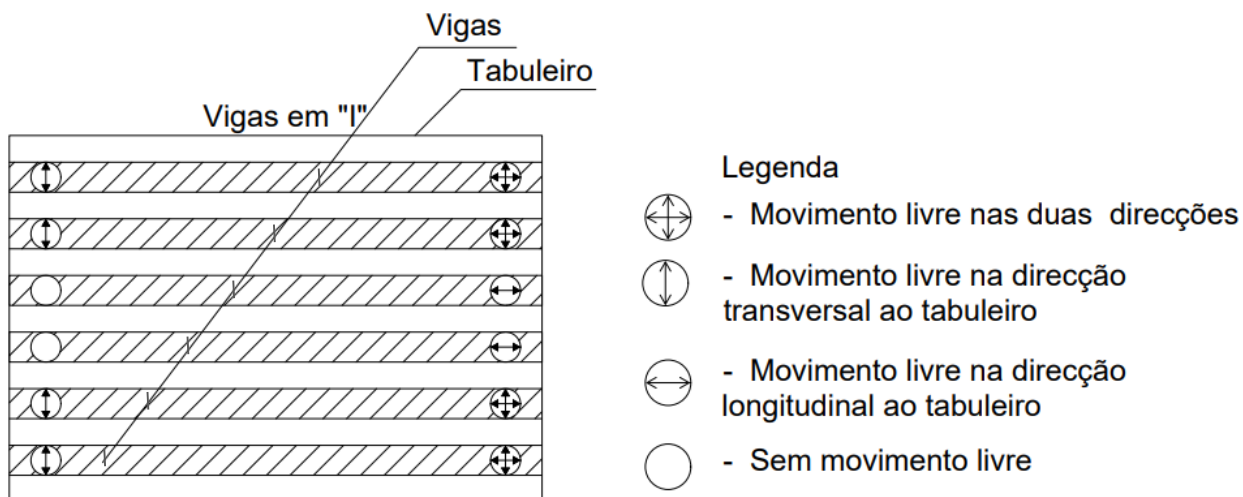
Representação dos aparelhos de apoio para o tabuleiro com vigas em "I".
